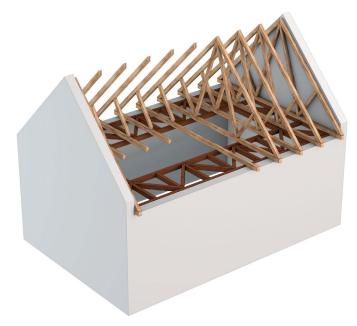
Exemple de contreventement d'une charpente à 2 versants par poutres au vent horizontales dans le plan des entraits
